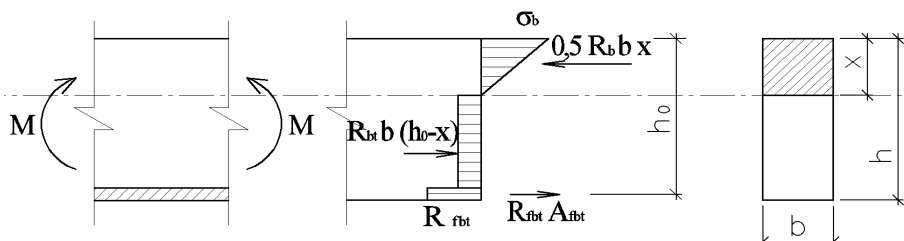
Схема распределения деформаций и напряжений в железобетонном сечении со сталефибробетонной опалубкой
